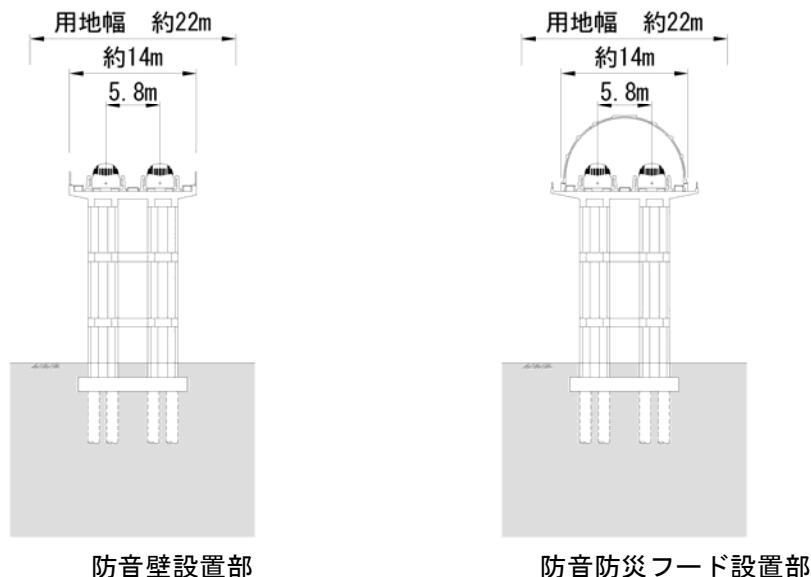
標準的な高架橋（新形式高架橋）の断面図
